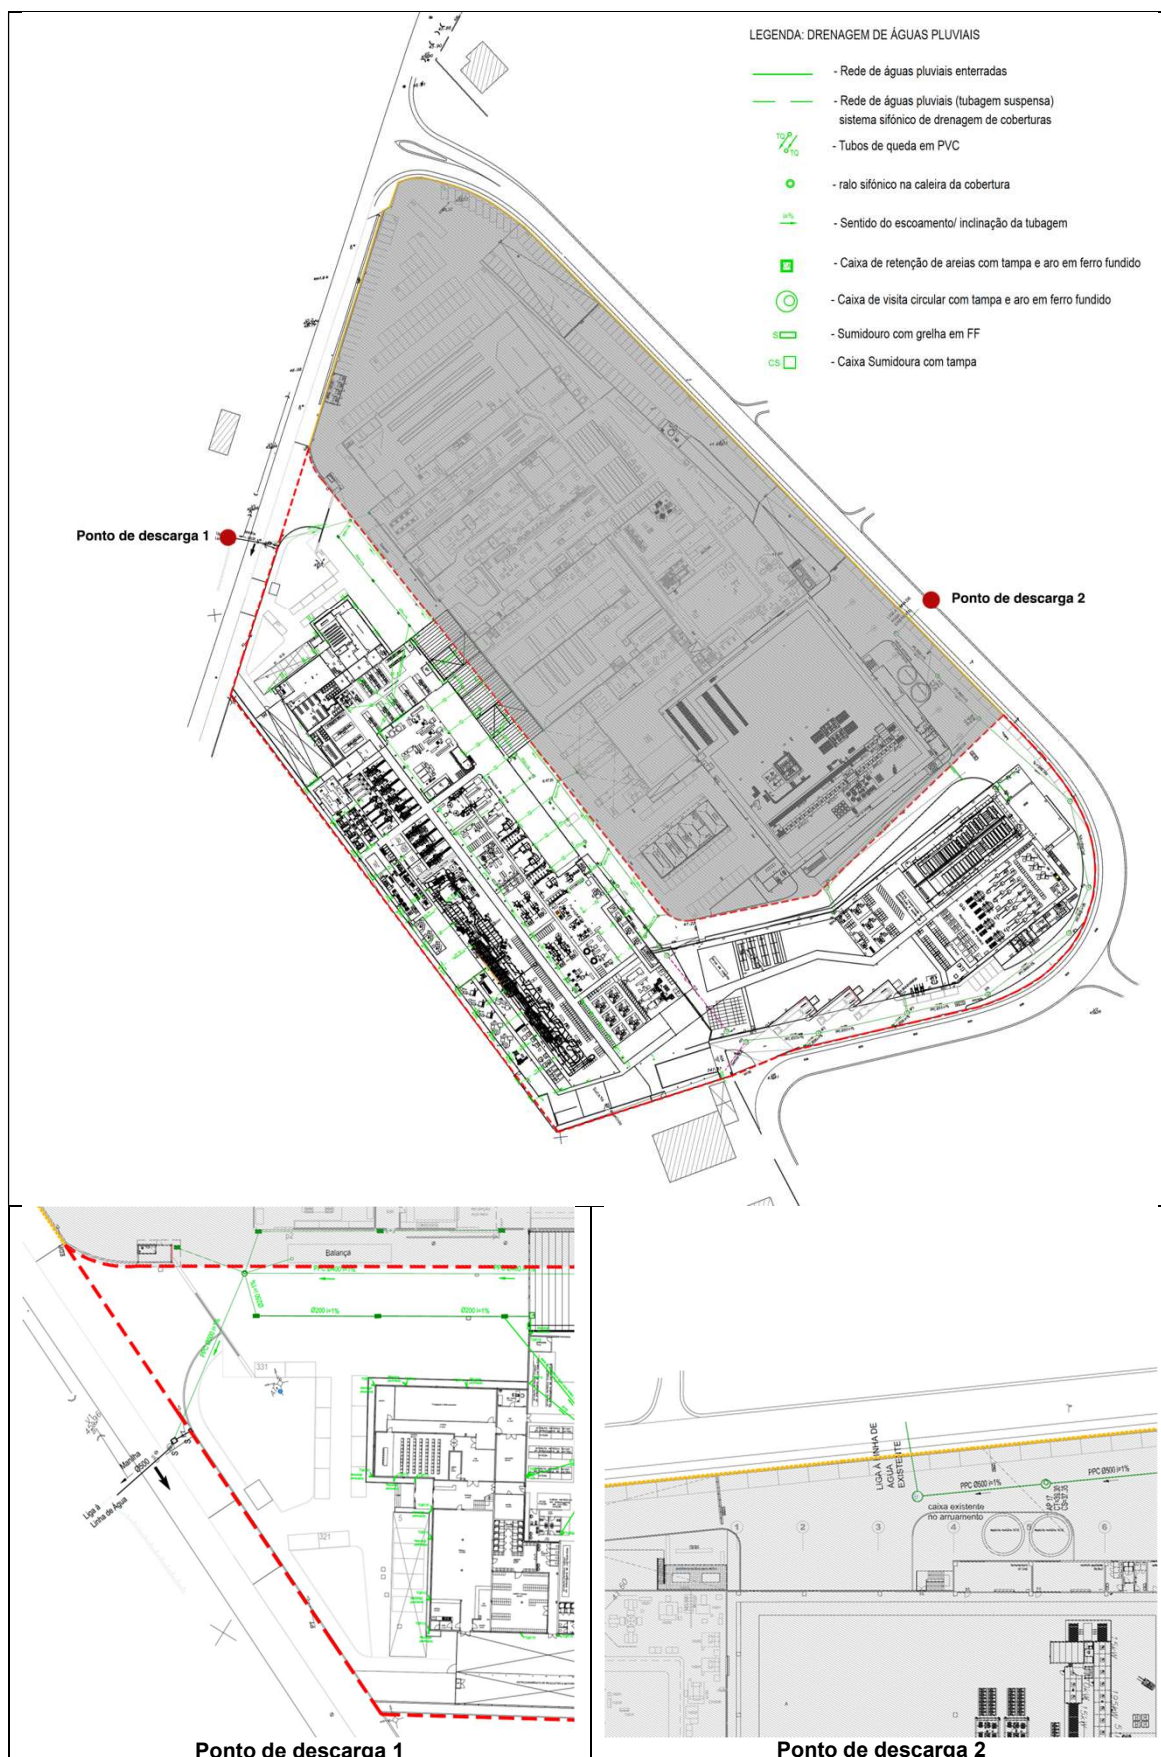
Planta de rede de águas pluviais e detalhe dos locais de descarga.
